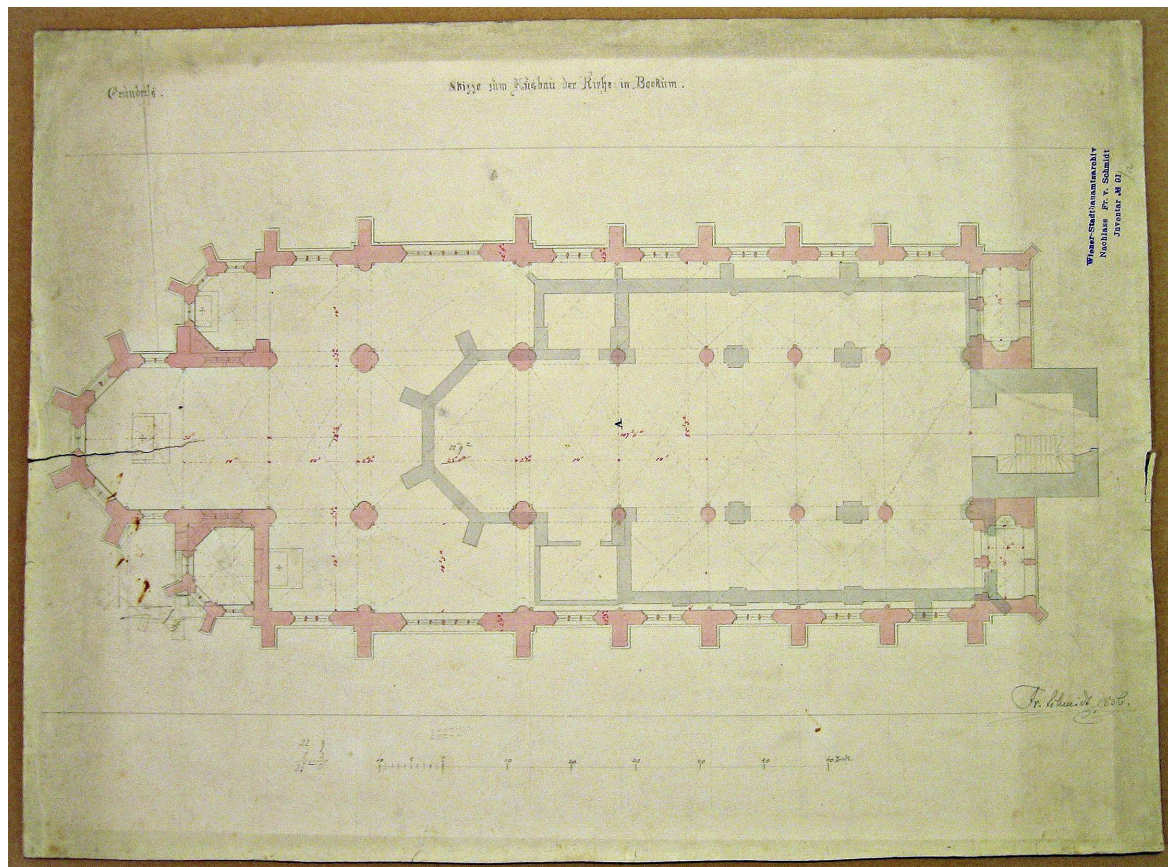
WM, Inv.-Nr. 157.91/12 zweiter Entwurf, Neubau, Grundriss
